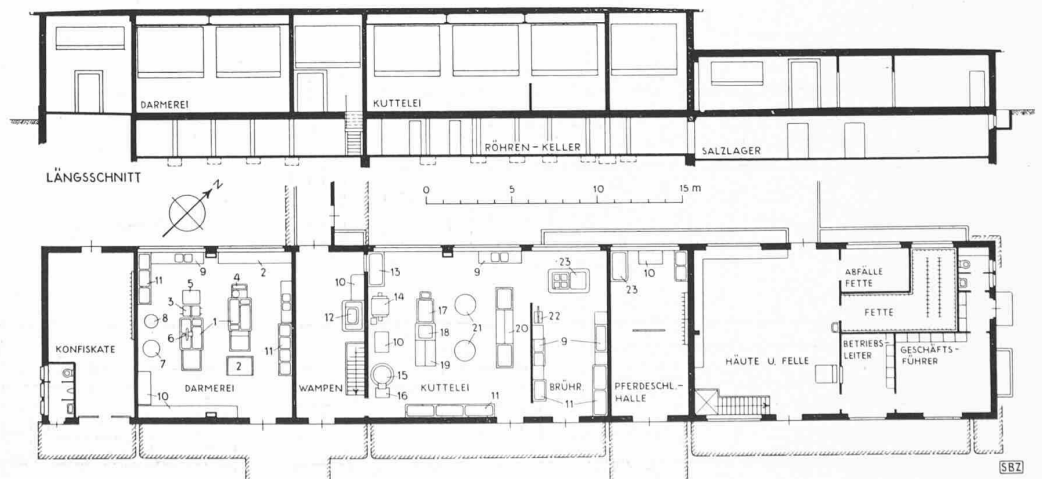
Grundriss und Längsschnitt des Nebenprodukten-Gebäudes. — Masstab 1 : 400
